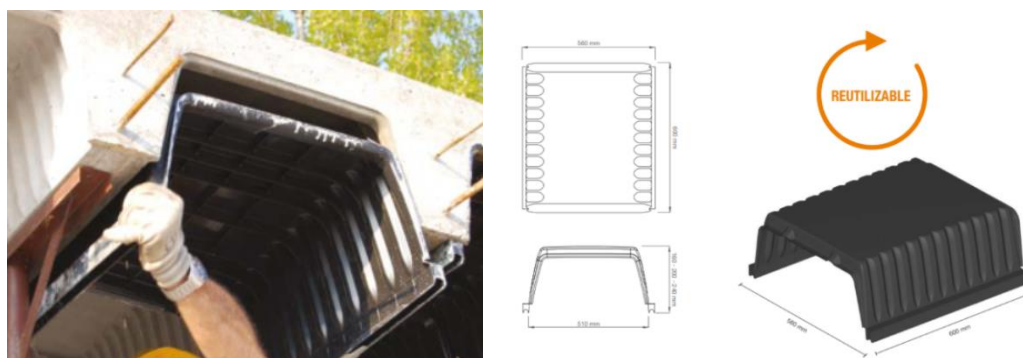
Sección de casetón para losa con viguetas. Fuente: [14].
